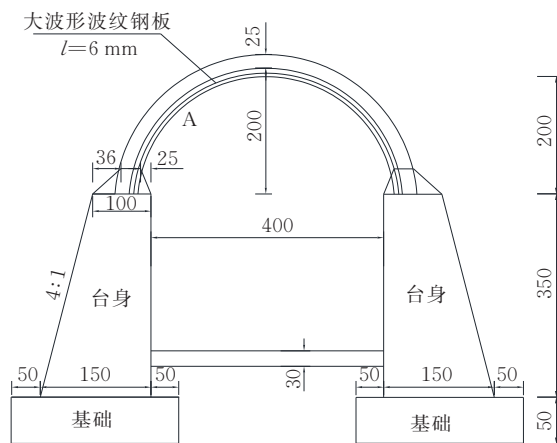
钢波纹板-混凝土组合拱涵断面图(单位:cm)
